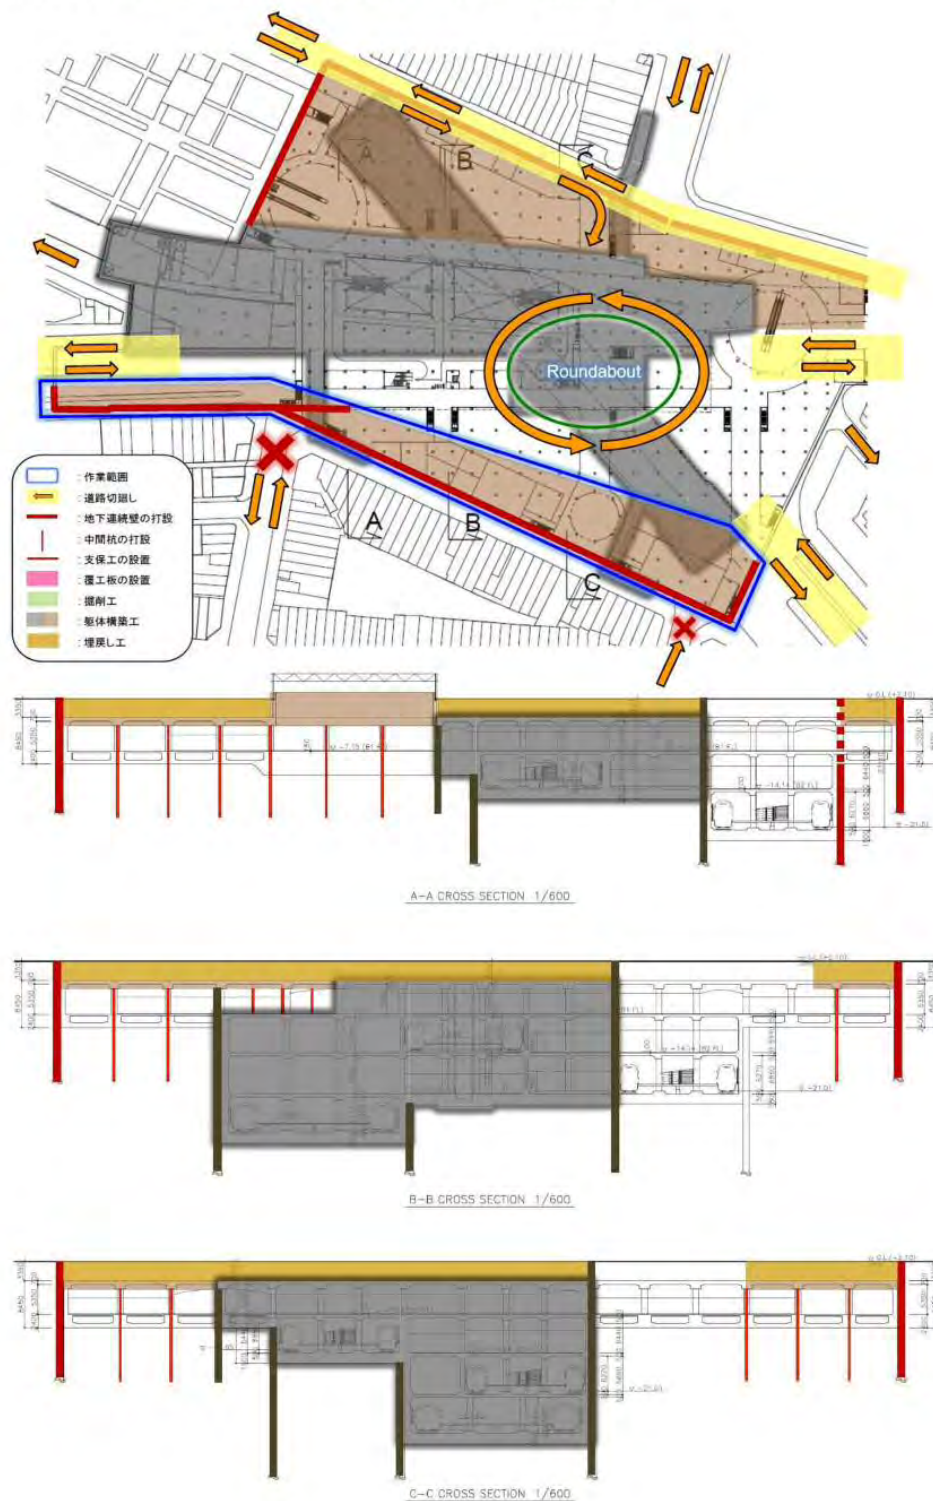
ベントイン総合駅の施工手順 (その 16/24)
